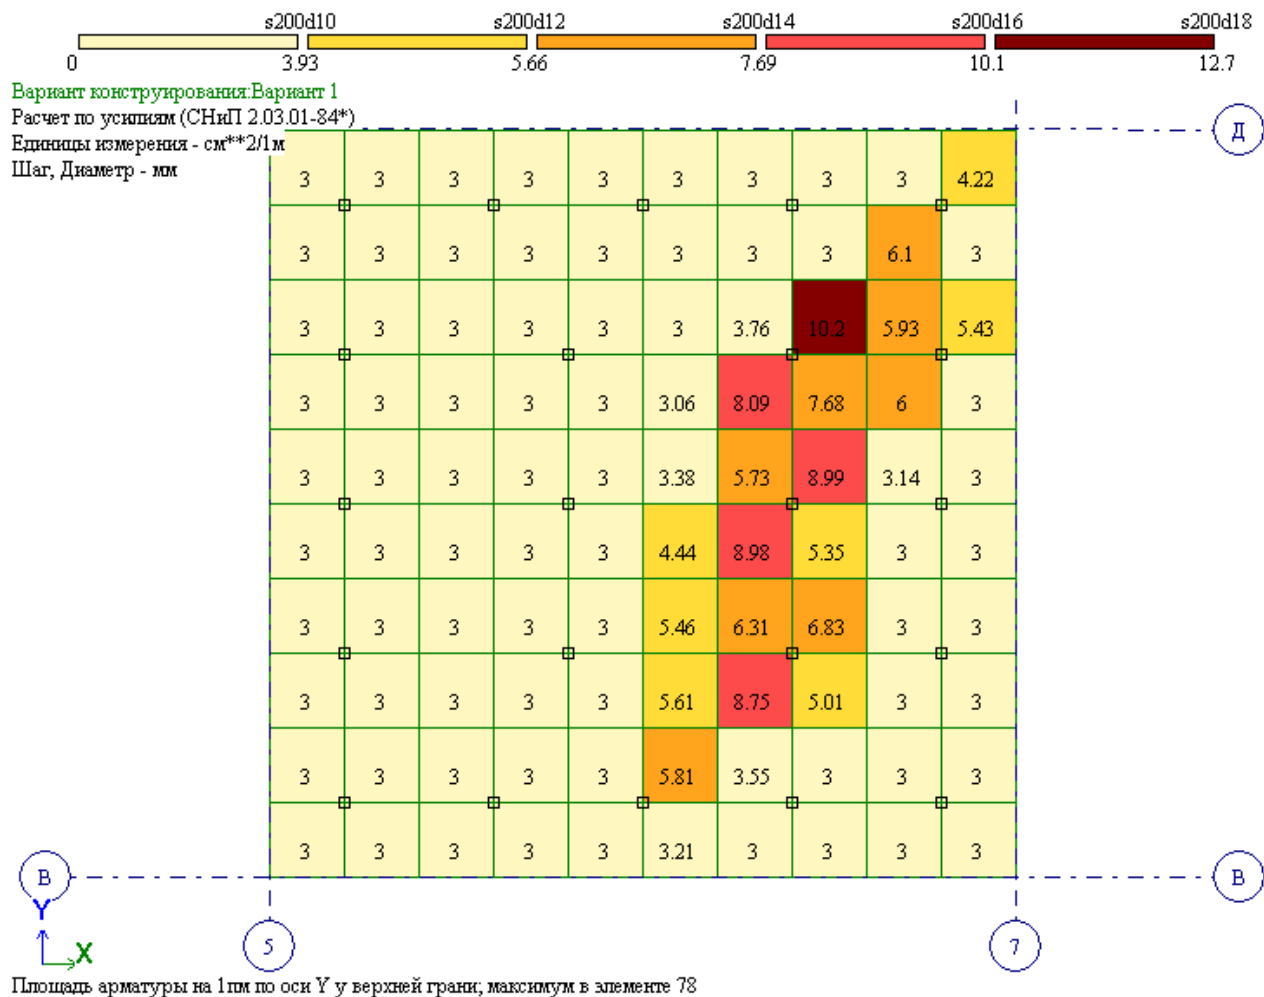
Площадь арматуры в плите по оси Y
